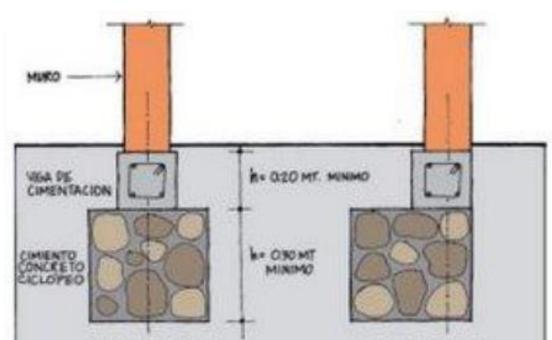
DETALLE ANCLAJE CIMENTACIÓN CON MUROS
